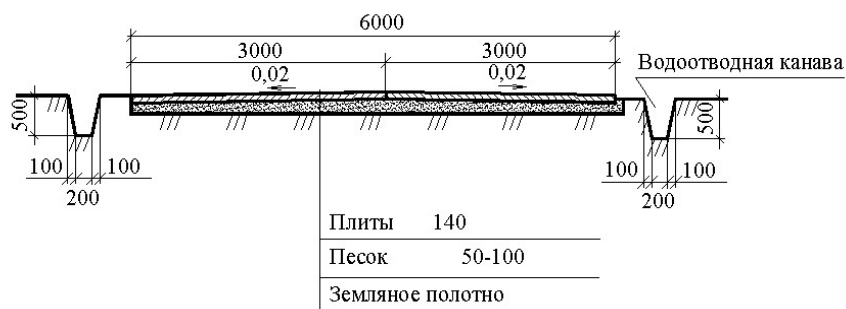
Тип 4. Двускатная дорога из сборных железобетонных плит шириной 5 м
